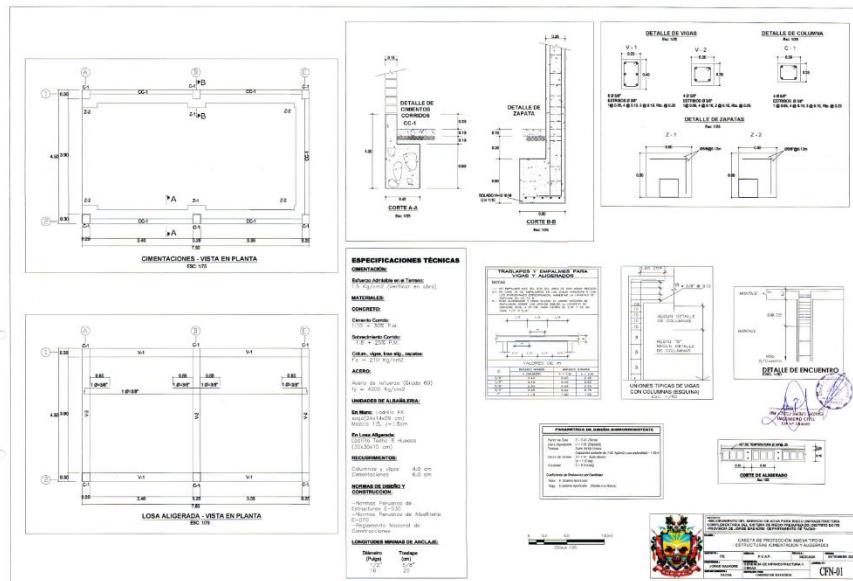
Plano de estructuras Caseta de filtrado R - A3.
